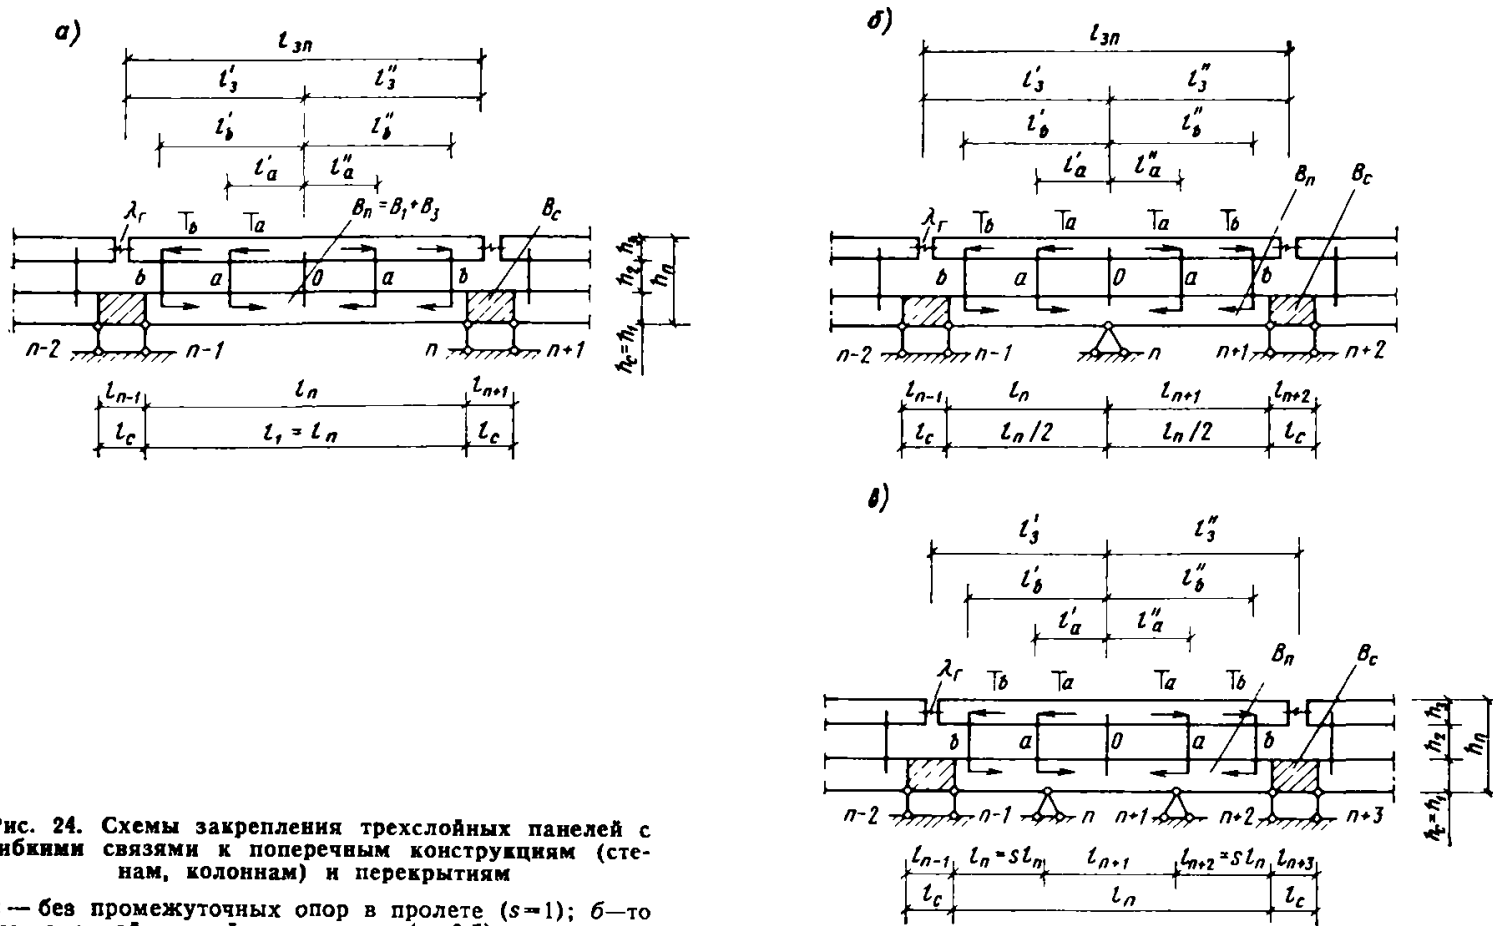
Схемы закрепления трехслойных панелей с гибкими связями к поперечным конструкциям (стенам, колоннам) и перекрытиям
